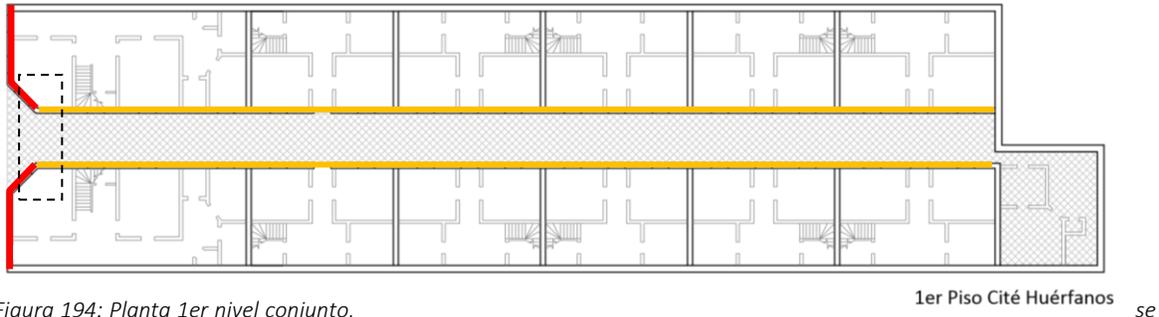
Planta 1er nivel conjunto, indica cambio de material y espesor. Rojo\_ Albañilería, Naranja\_ Tabiquería rellena de adobe.
